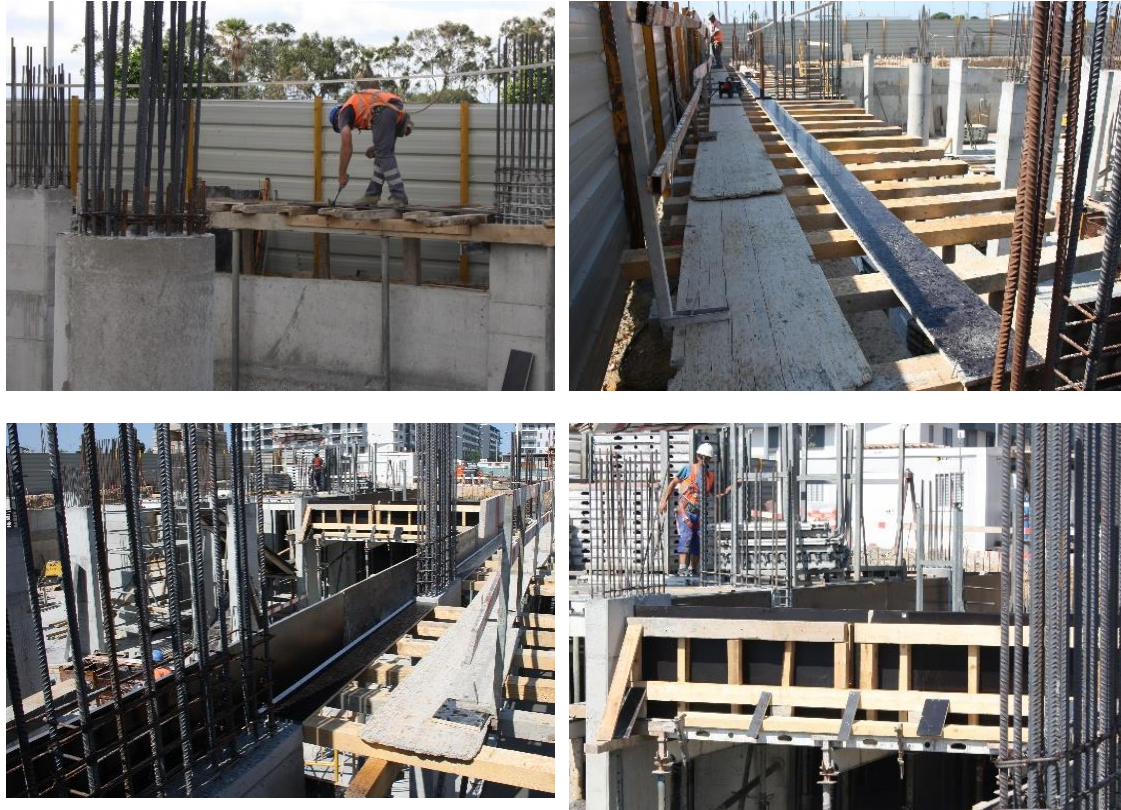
Execução da cofragem de fundo de viga de bordadura.
